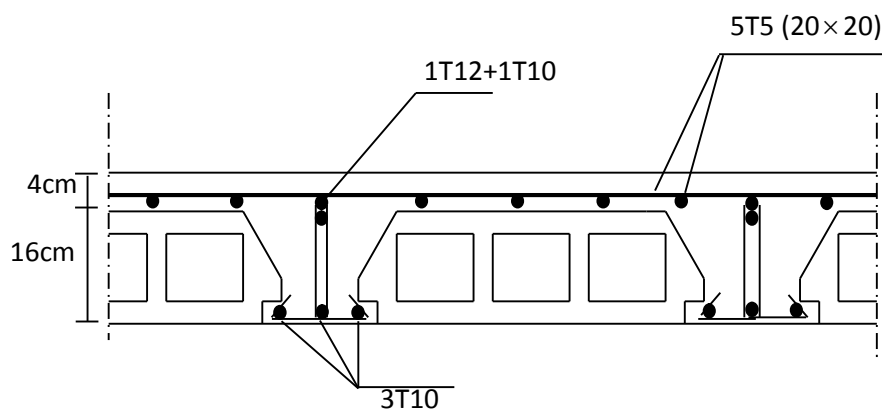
plan de ferrailage du plancher étage courant habitation.
